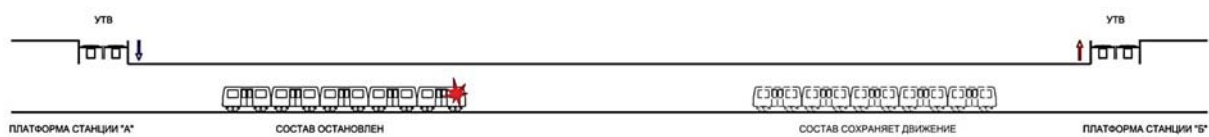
Продольная схема противодымной вентиляции без промежуточной УТВ
